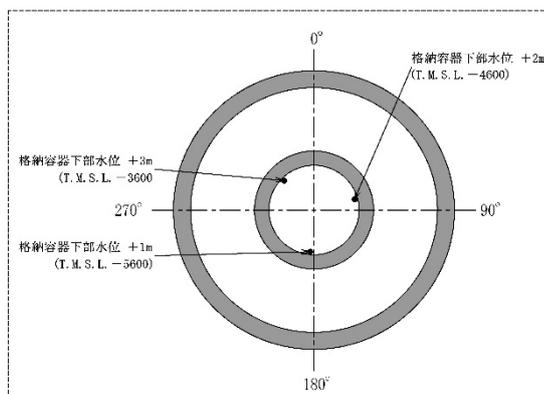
格納容器下部水位計配置図(図2-1の真上平面) 図2-3 格納容器下部水位計取付図
